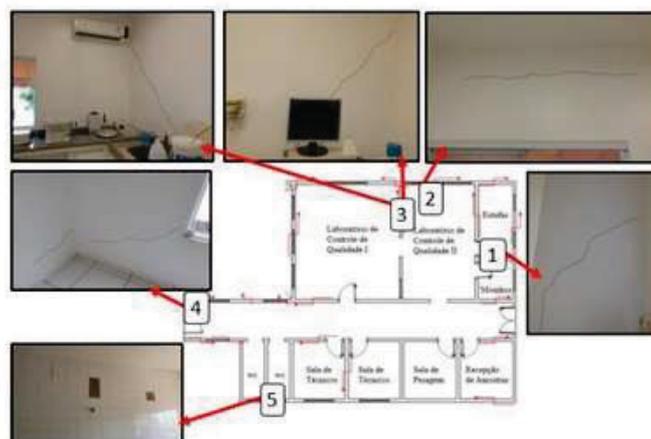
Ilustração dos pontos com Aberturas na alvenaria no pavimento térreo da Laboratório.
